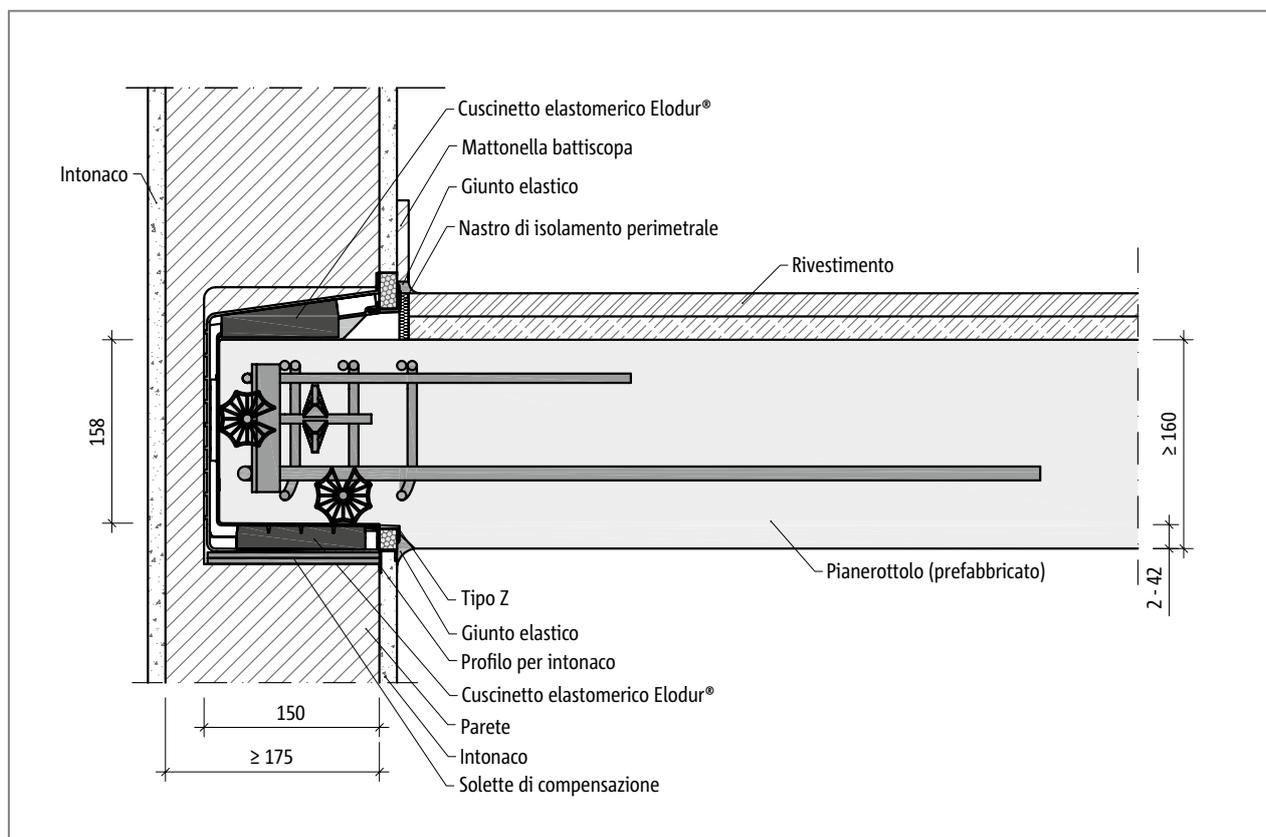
Schöck Tronsole® tipo Z-V+V-T: sezione costruttiva - Pianerottolo prefabbricato
